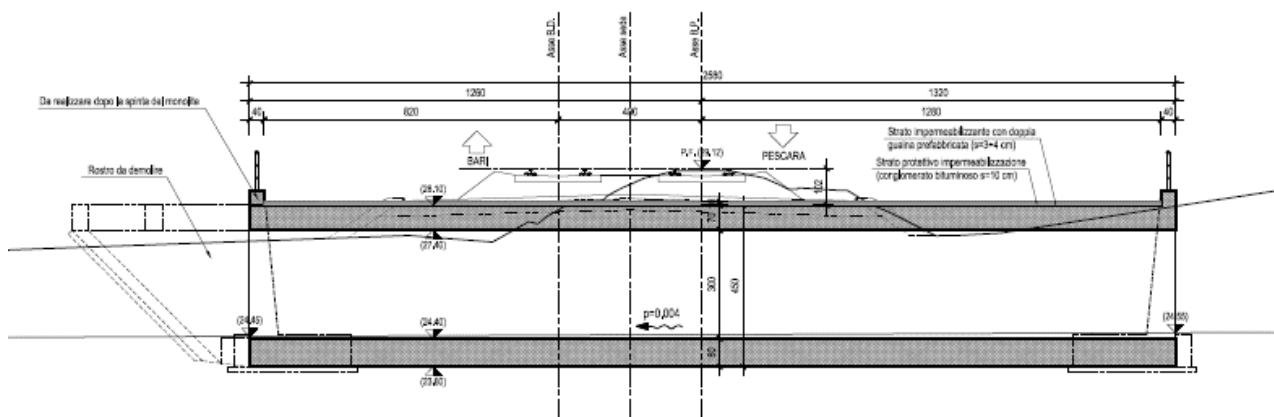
Adeguamento idraulico Fosso Pontonicchio - Sezione Longitudinale
